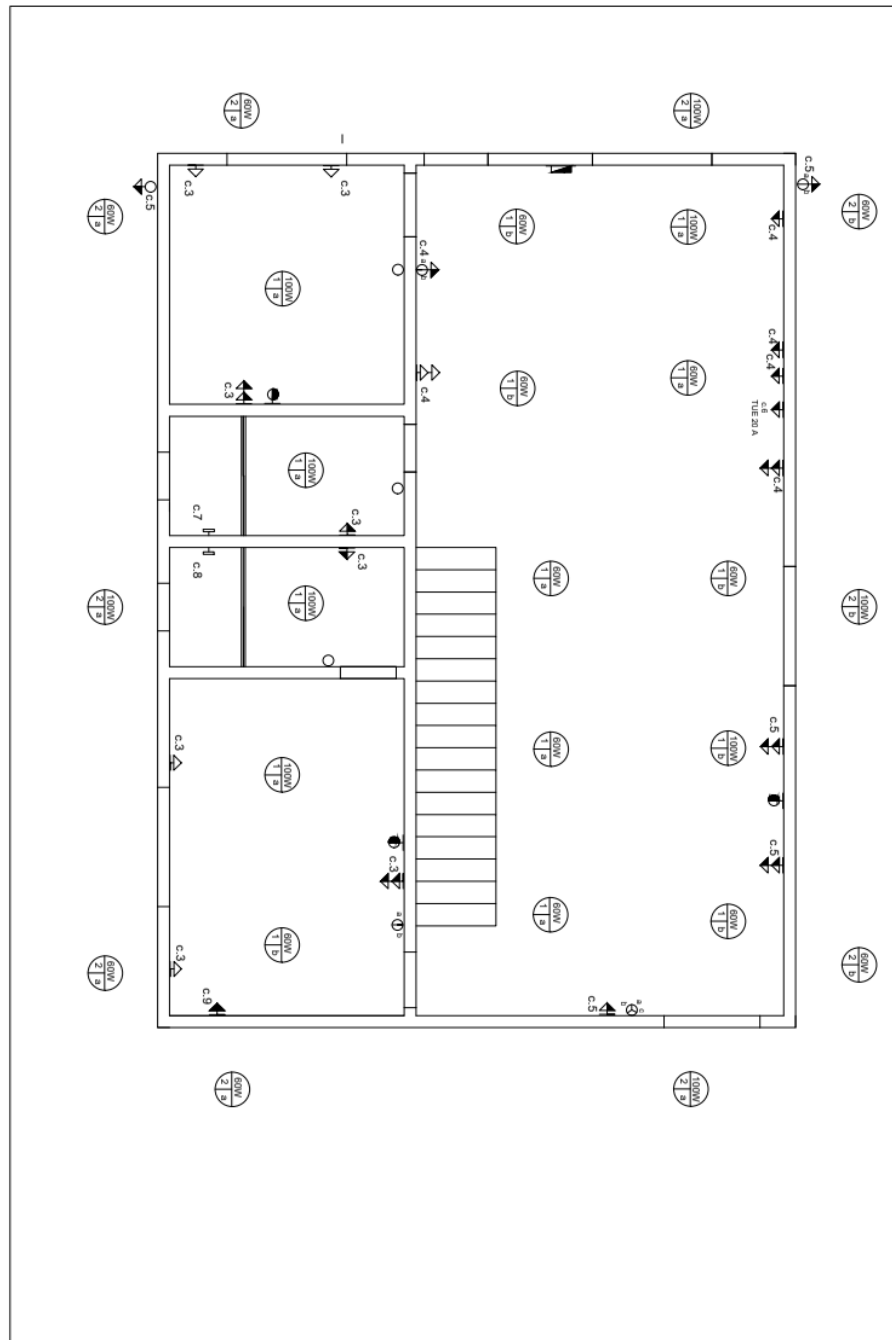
Planta baixa pontos de iluminação, tomadas e interruptores pavimento térreo
